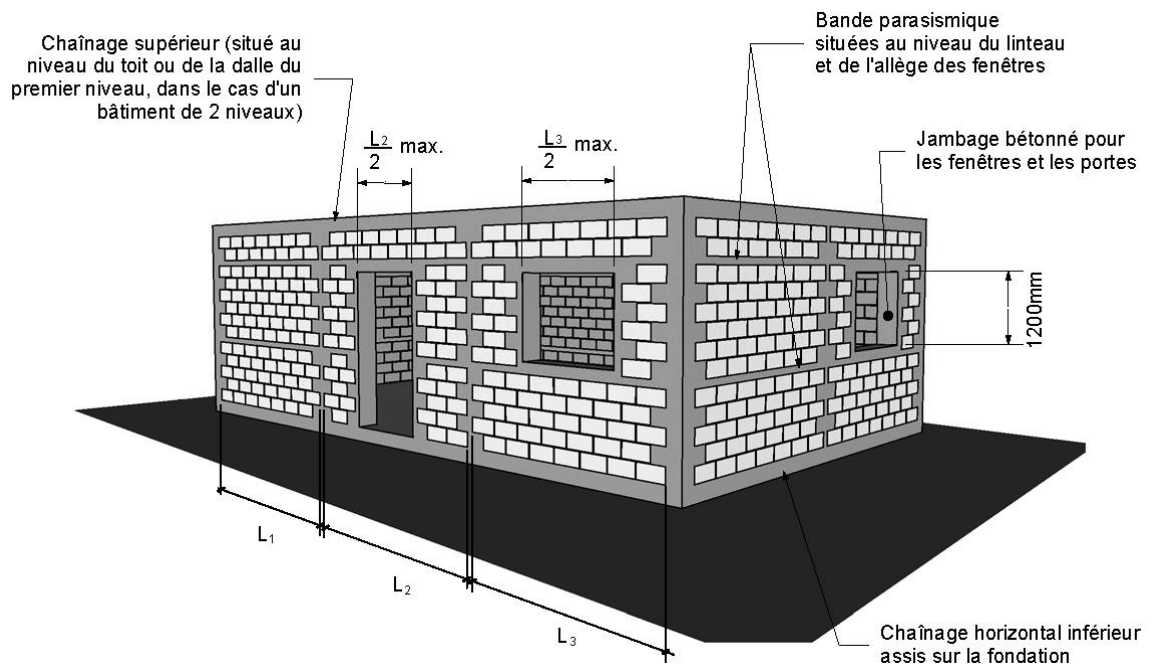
a - Disposition typique des bandes parasismiques et ferrailage d'ouvertures dans un bâtiment en maçonnerie
